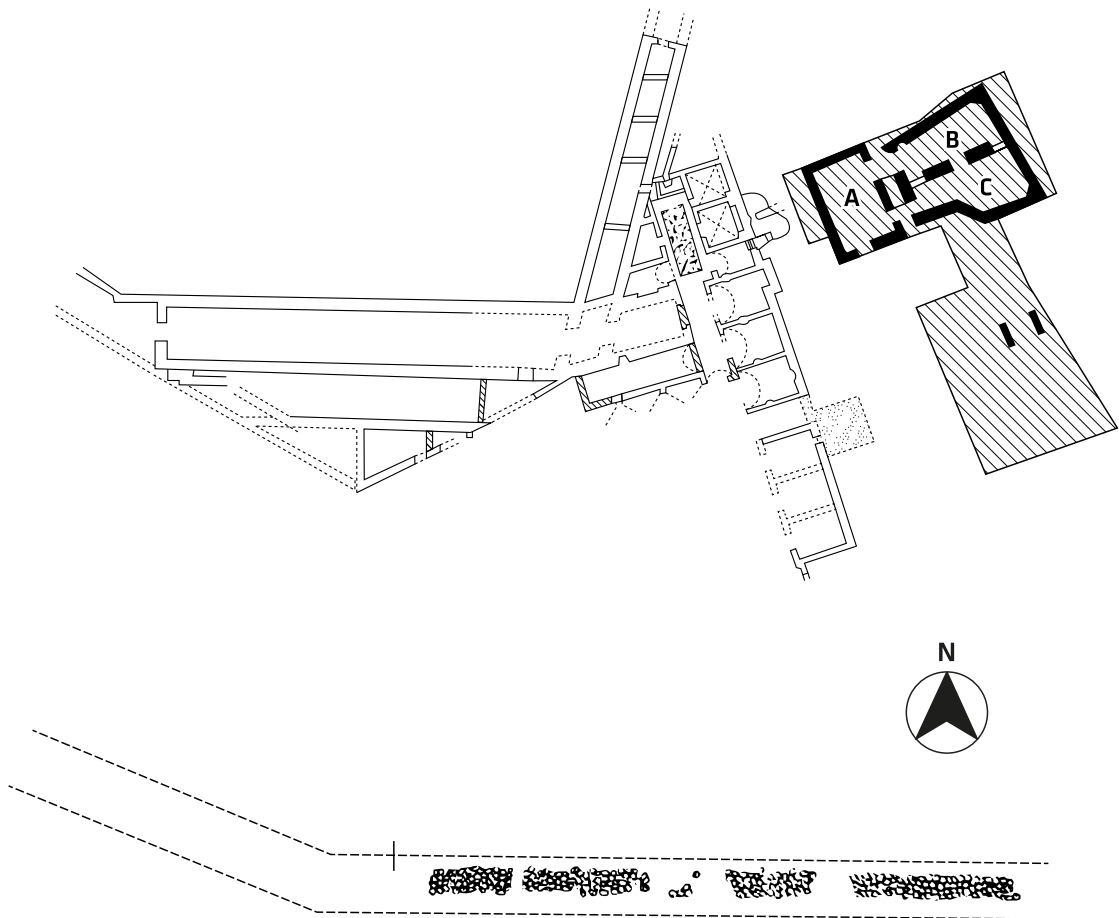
Terracina, chiesa di Santa Maria Maddalena - Villa Salvini, pianta. ⁽¹⁾
